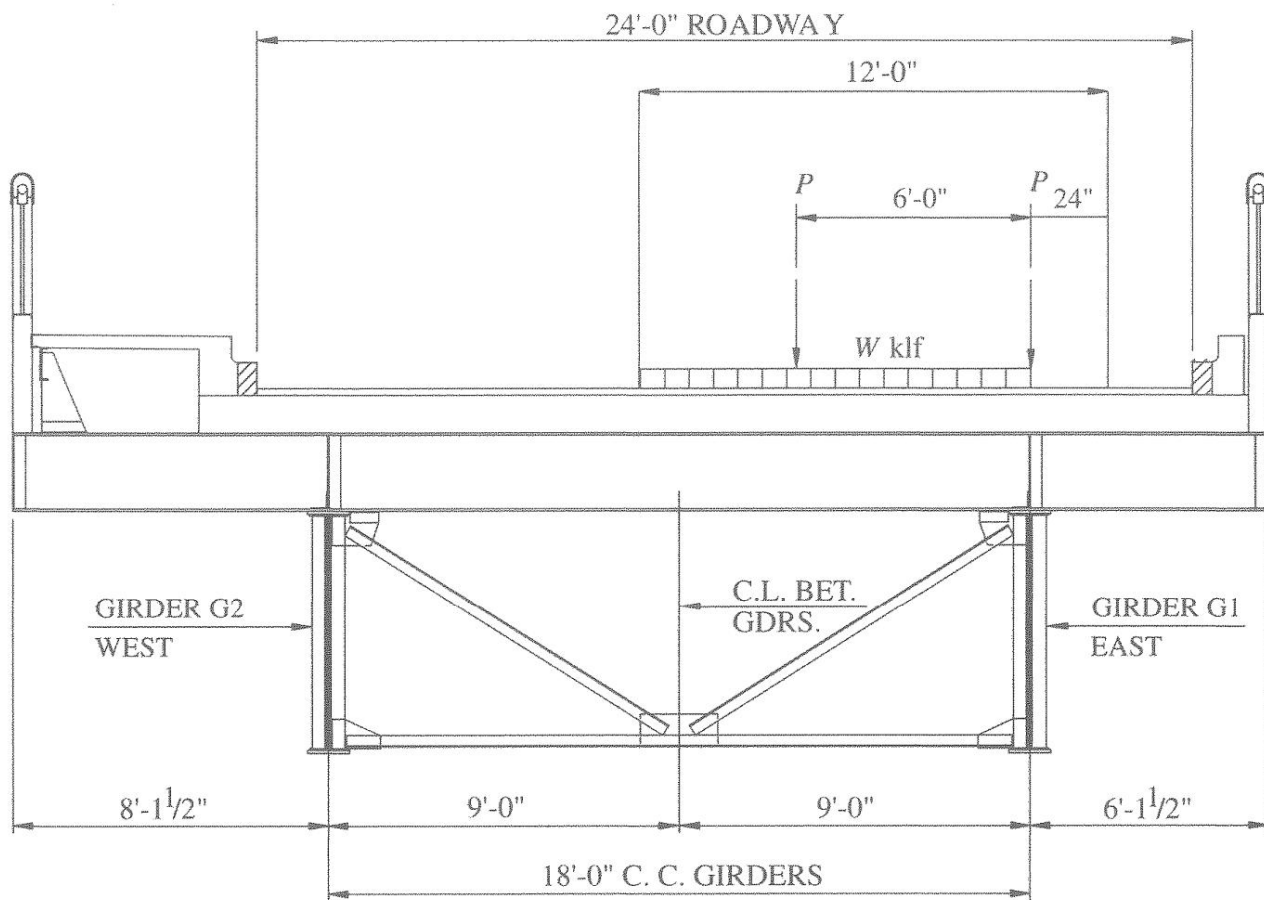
Posición crítica para producir el corte máximo en la viga del piso
